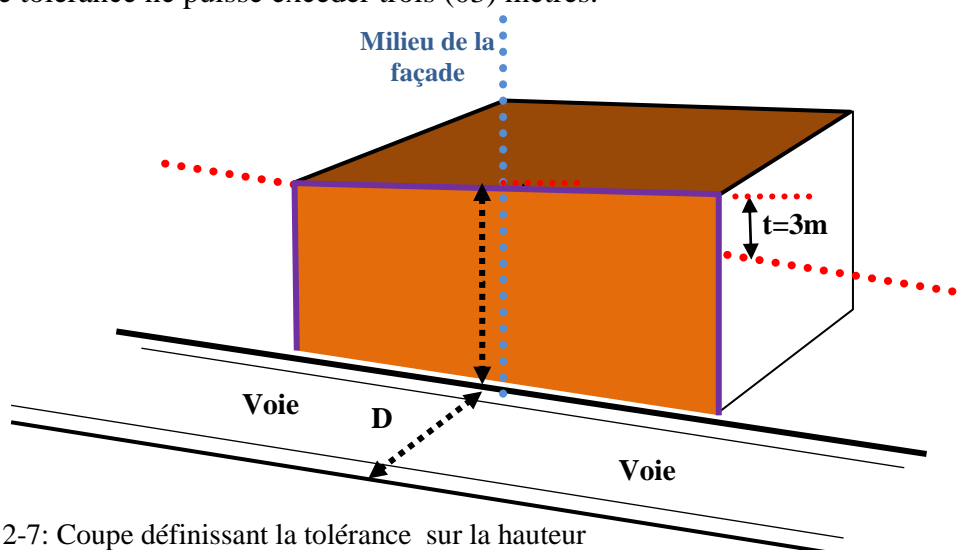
Coupe définissant la tolérance sur la hauteur d'une construction en bordure d'une voie en pente.
